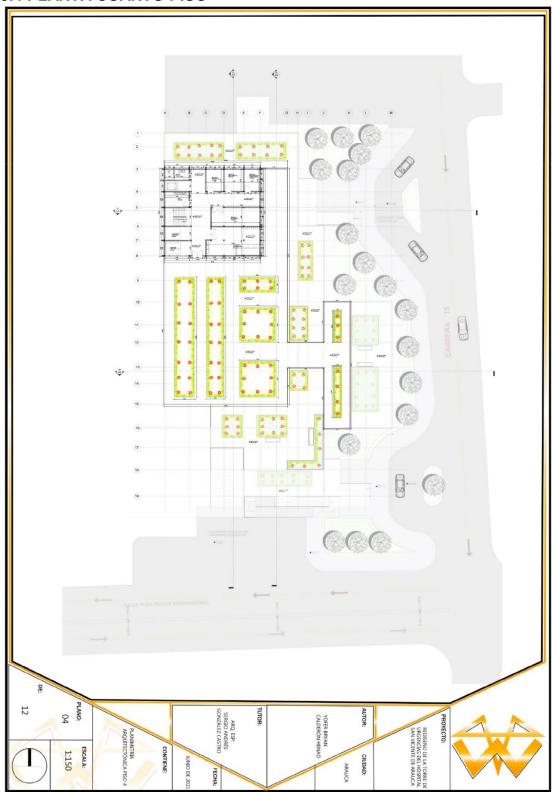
Planta cuarto piso. Fuente: elaboración propia
